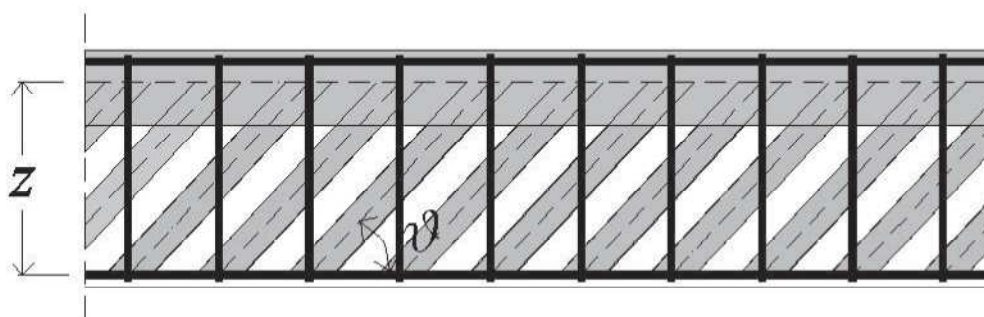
Modello a traliccio con struttura d'anima tradizionale
